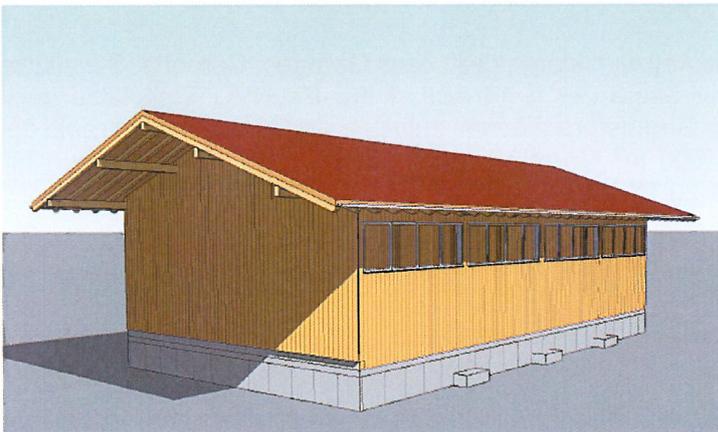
Skizze geplante Lagerhalle in Holzbauweise
